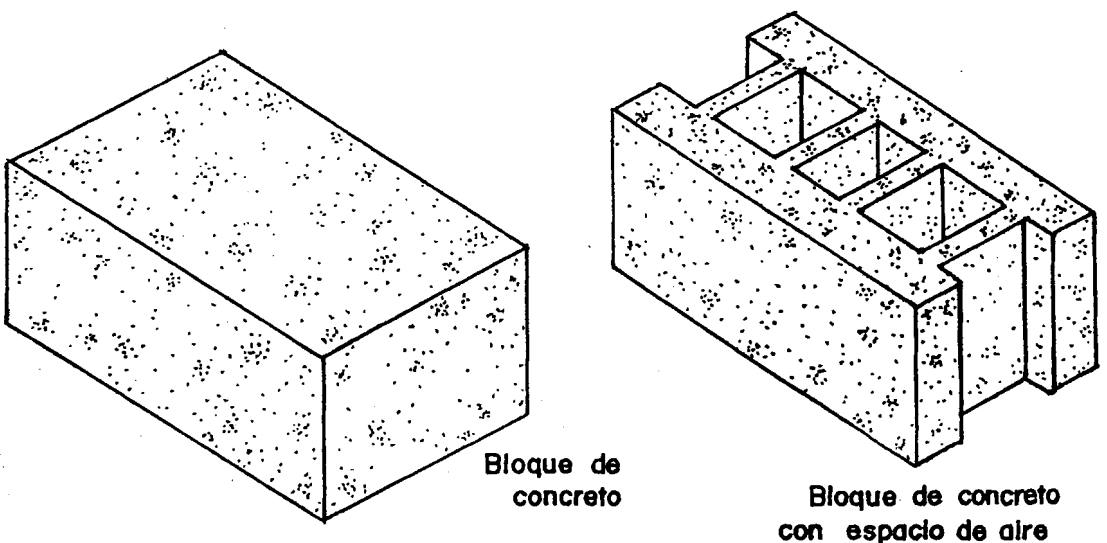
TIPOS DE BLOQUES PARA LA CONSTRUCCION DE PAREDES EXTERIORES
